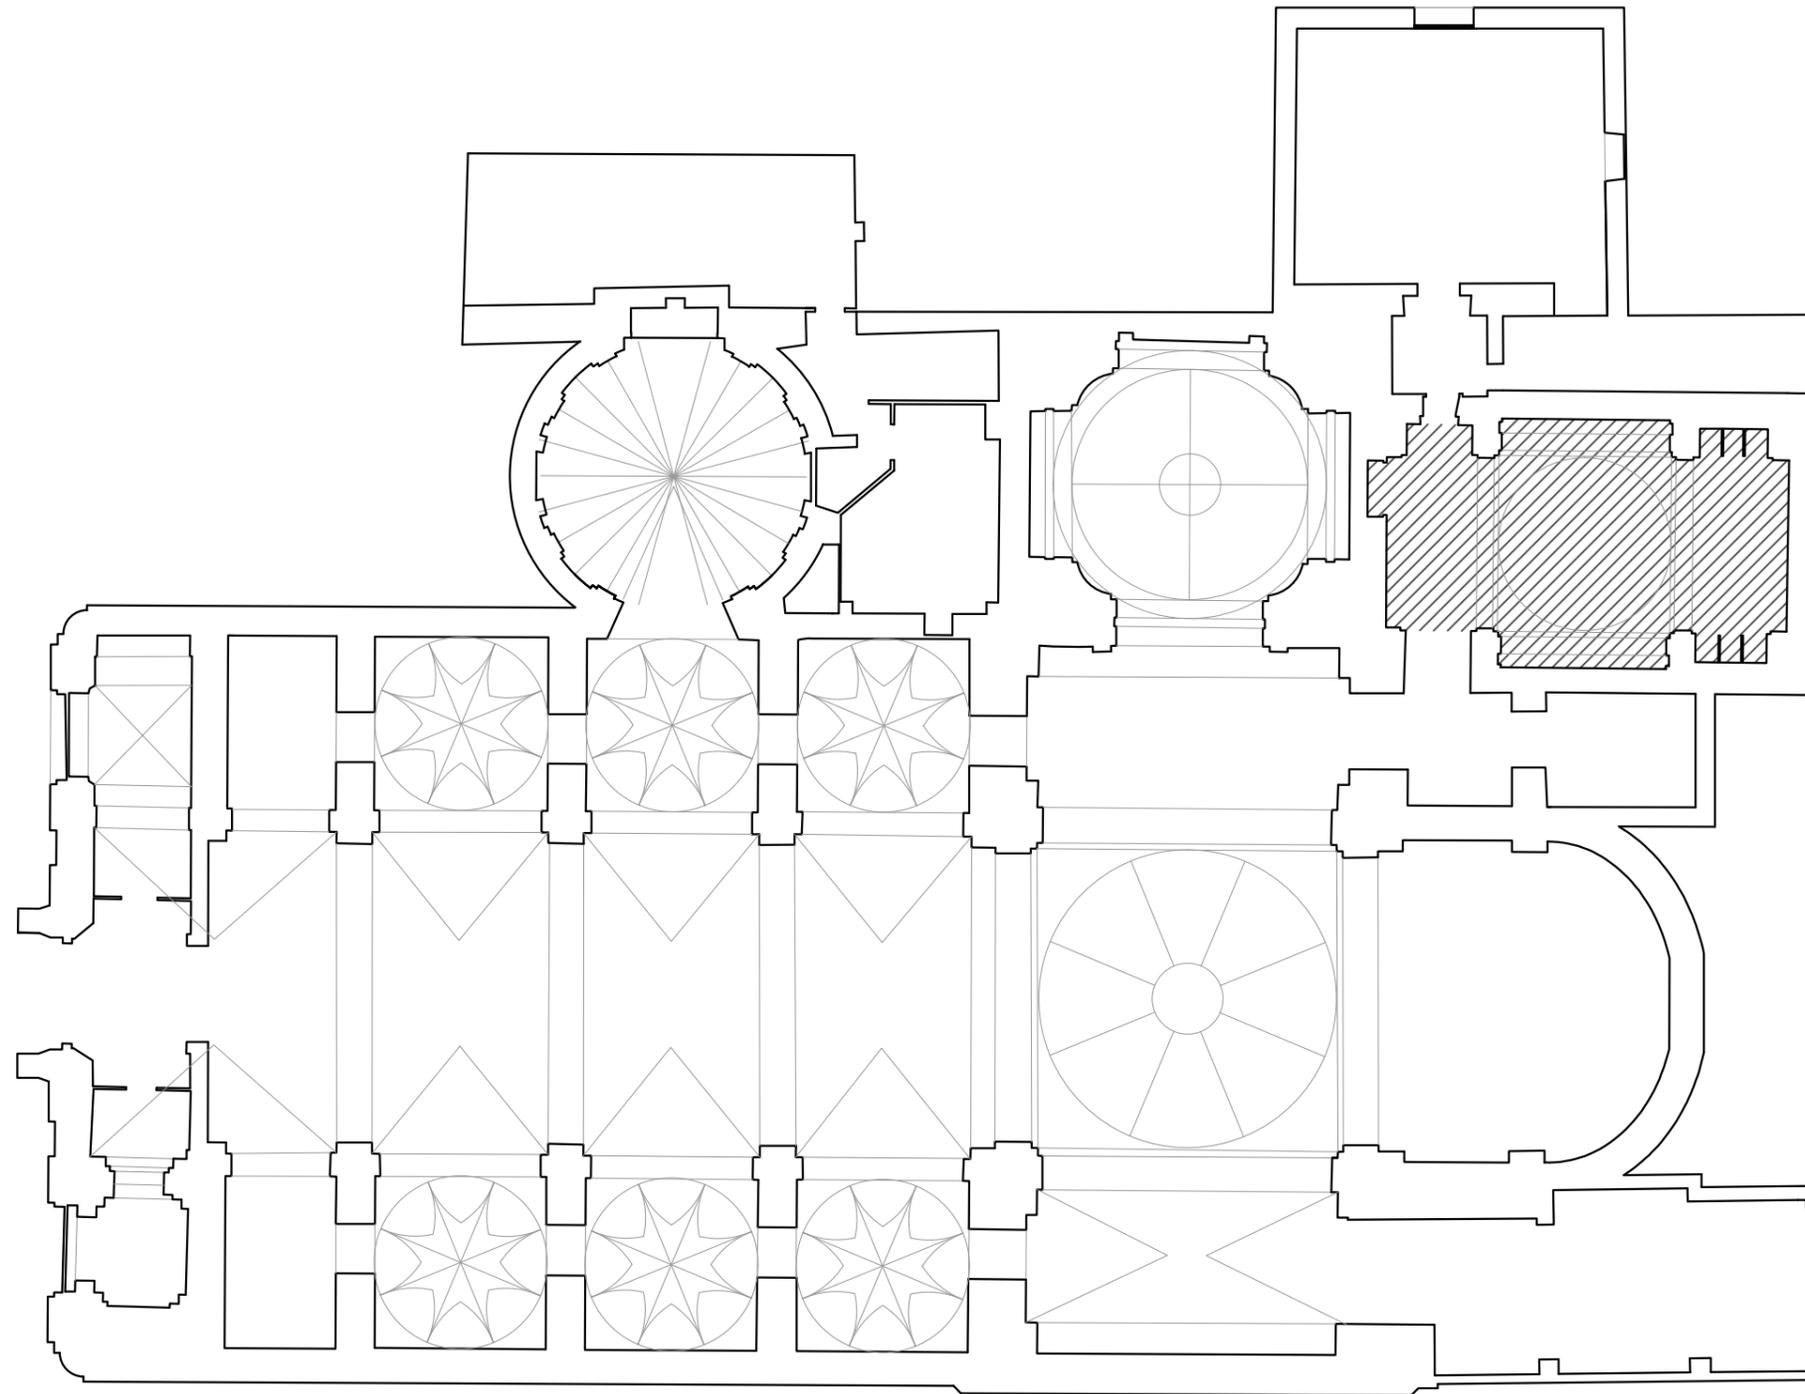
Imagen Pavimento (Mármol Rosa Buixcarrò) 72
